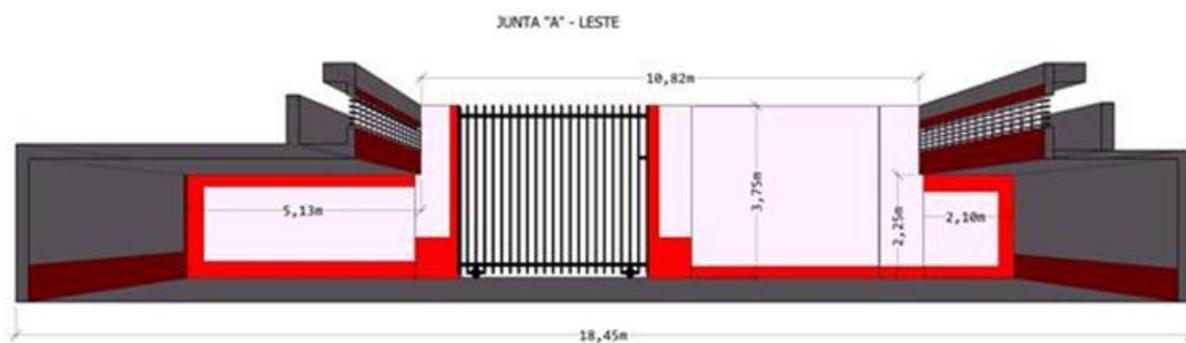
Vista Leste – Junta A com os pontos de reparação destacados em vermelho.
